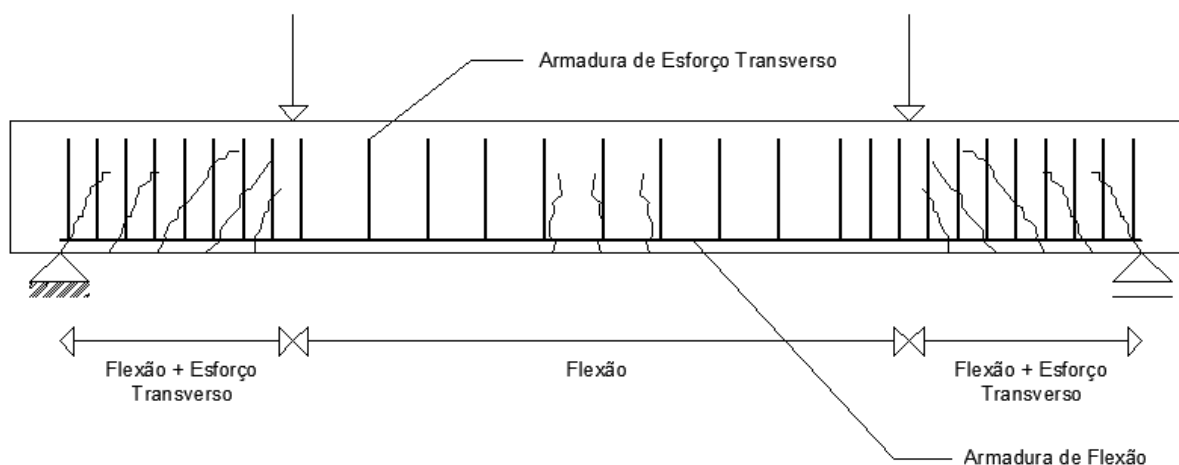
Esquema de viga de betão armado fendilhada dotada de armadura de flexão e de esforço transversal.
